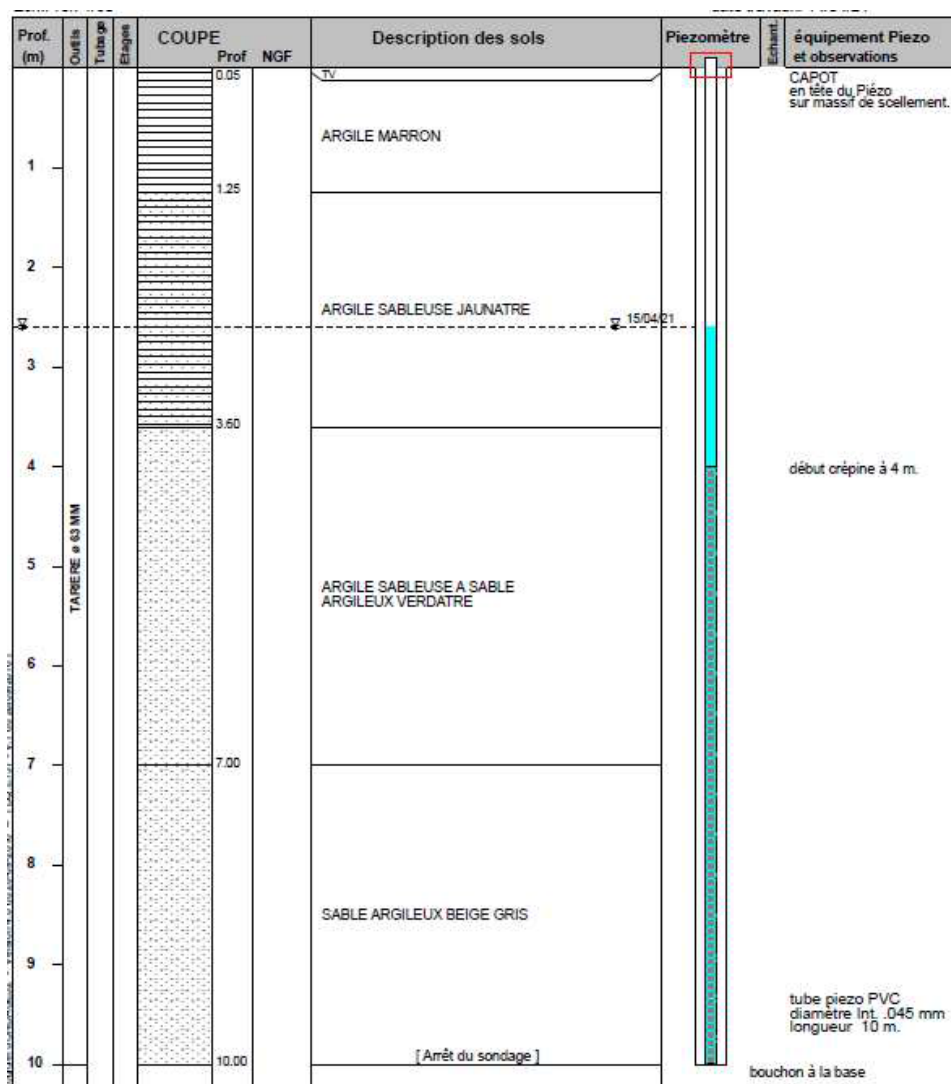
Extrait de la coupe du piézomètre installé au droit du futur bassin
